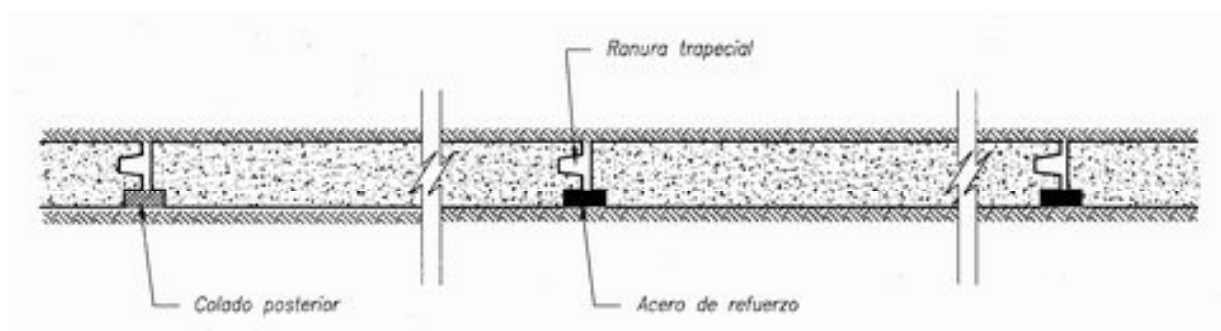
, Junta tipo ISTME para muros prefabricados
